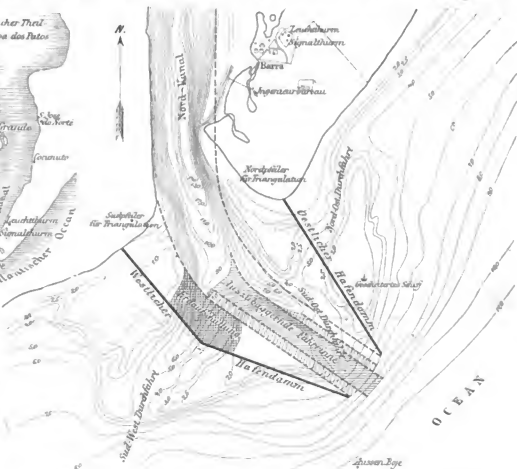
Lageplan der Barre zu Rio Grande do Sul.
